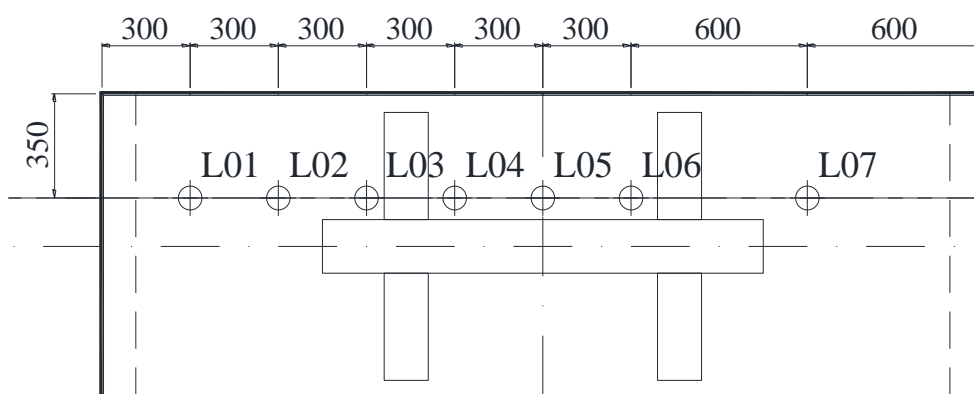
Localização dos LVDT's nas lajes ensaiadas
